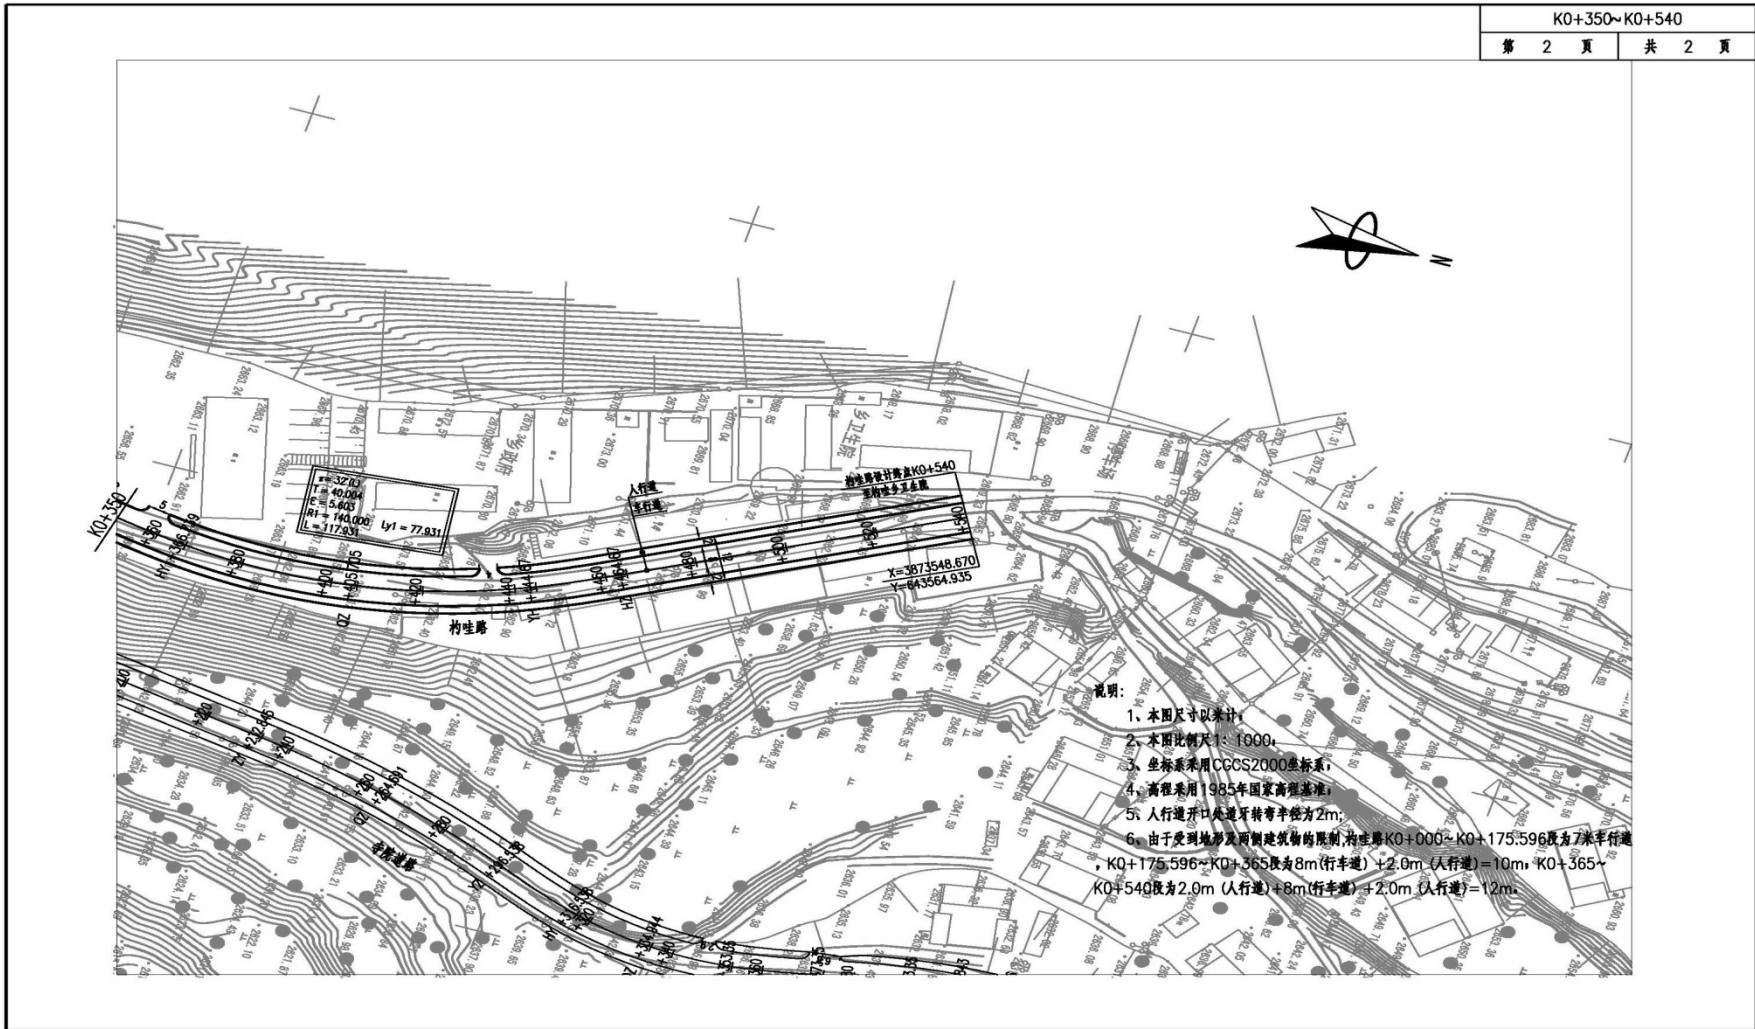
构哇路 K0+350- K0+540 段平面布置图
